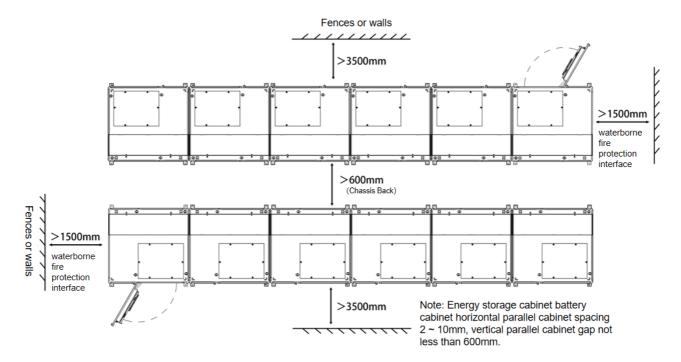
Installazione armadio in parallelo per Armadio di accumulo (retro a retro)
